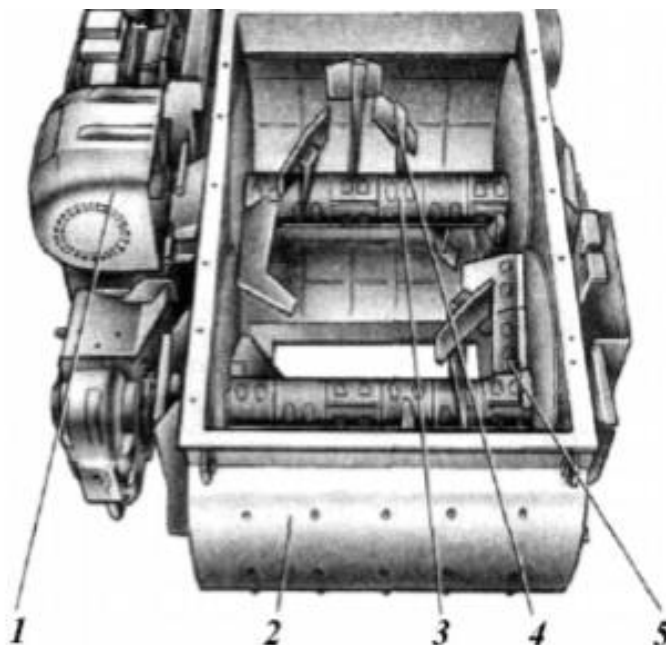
Двухвальный смеситель циклического действия с принудительным перемешиванием: 1 – привод валов; 2 – корпус; 3 – вал; 4 – лопасть; 5 – разгрузочный люк.
